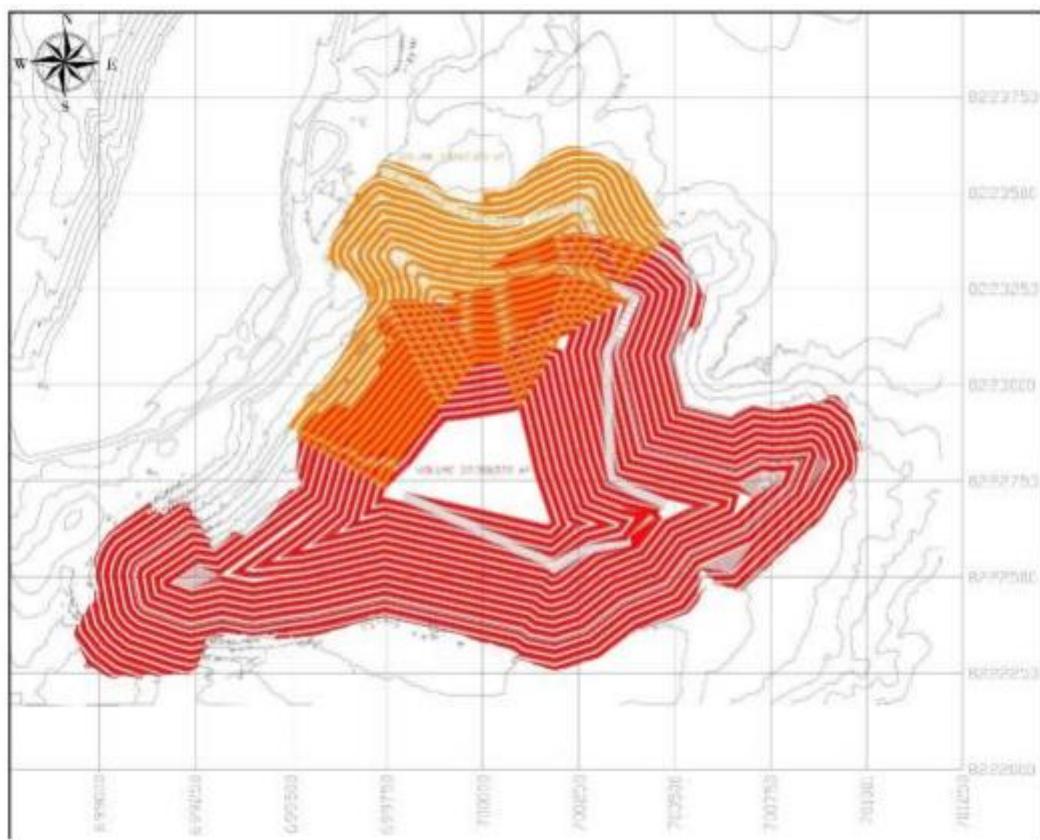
Pilha de Estéril com destaque para a área de retaludamento (vermelho) e posterior expansão a Norte (laranja). Fonte: EIA, 2024
